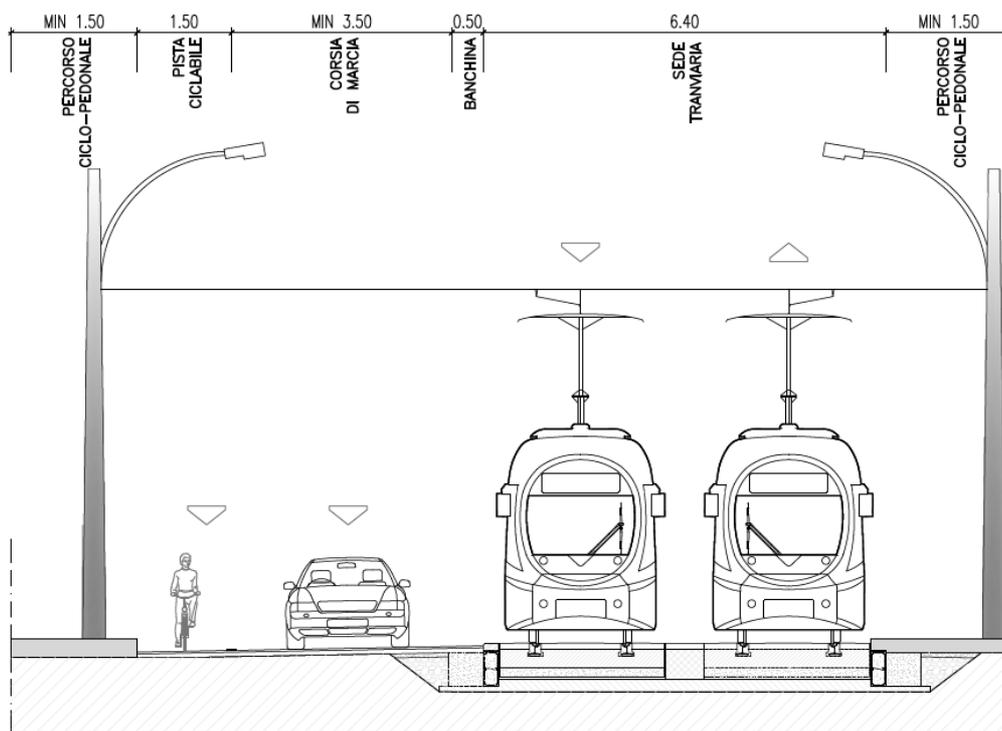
Via Emilio Lepido nel tratto precedente il sottovia autostradale – Sezione trasversale di progetto
